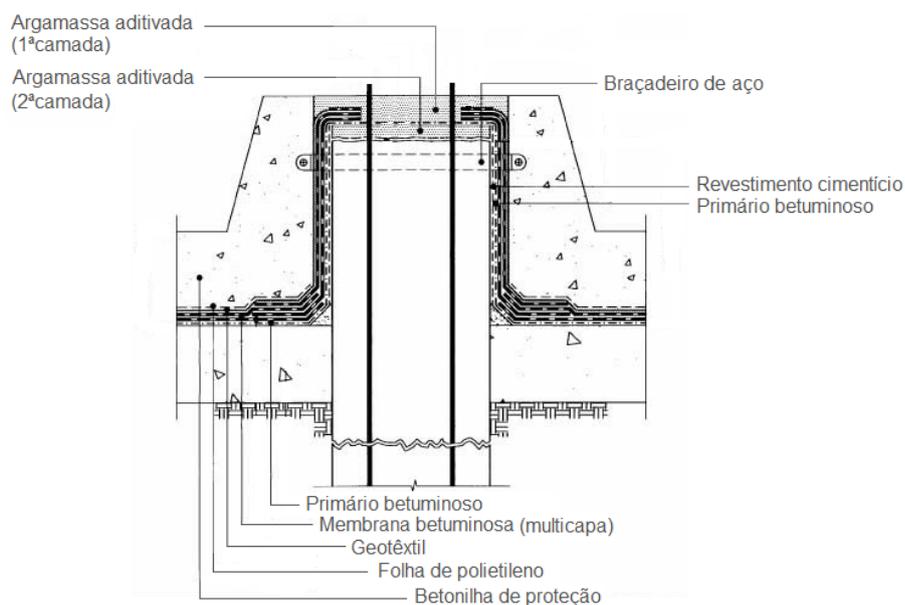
Impermeabilização de estacas com membranas de betume polímero (Sitaf@ 2014)
